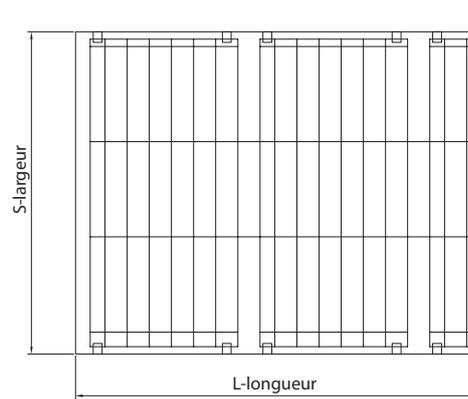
Vue de haut du grillage de protection monté sur un lanterneau continu
